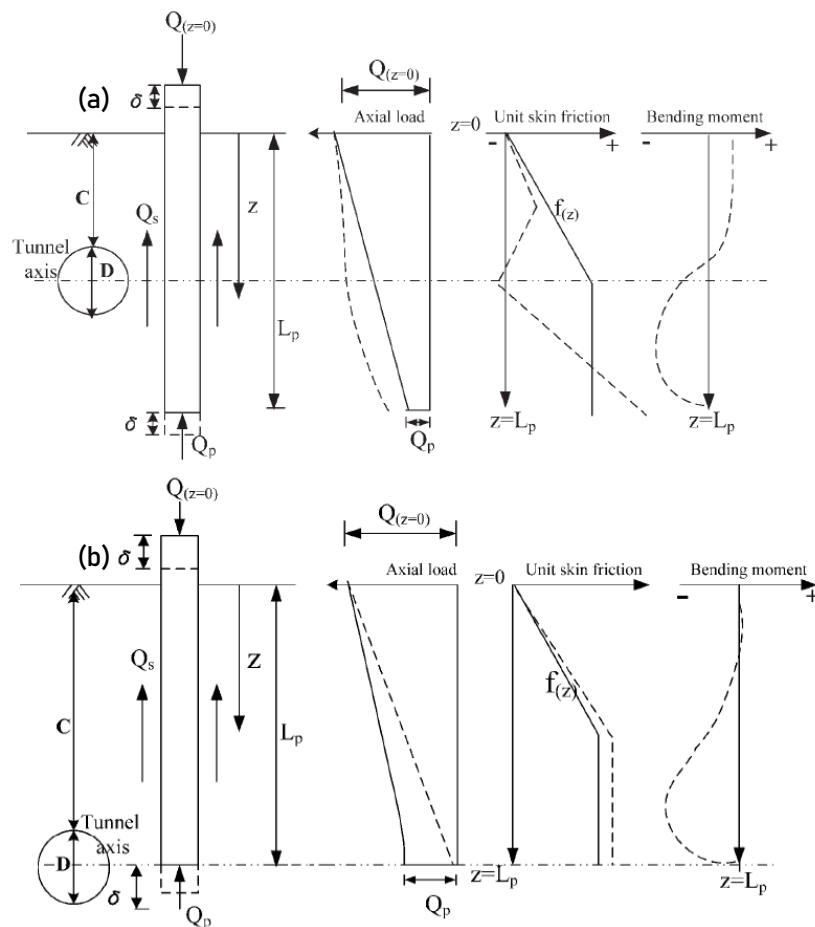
Mécanisme de déformation des pieux suite au creusement (a) pieu sous le tunnel (b) pieu au niveau de l'axe du tunnel (Lee & Chiang, 2007)
